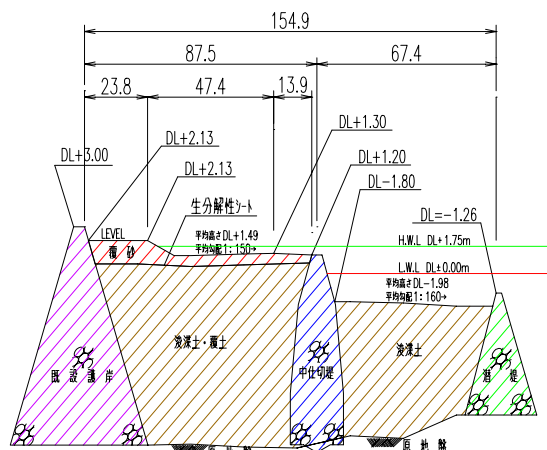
干潟完成断面図 (A-A 断面 H:V=1.5)
